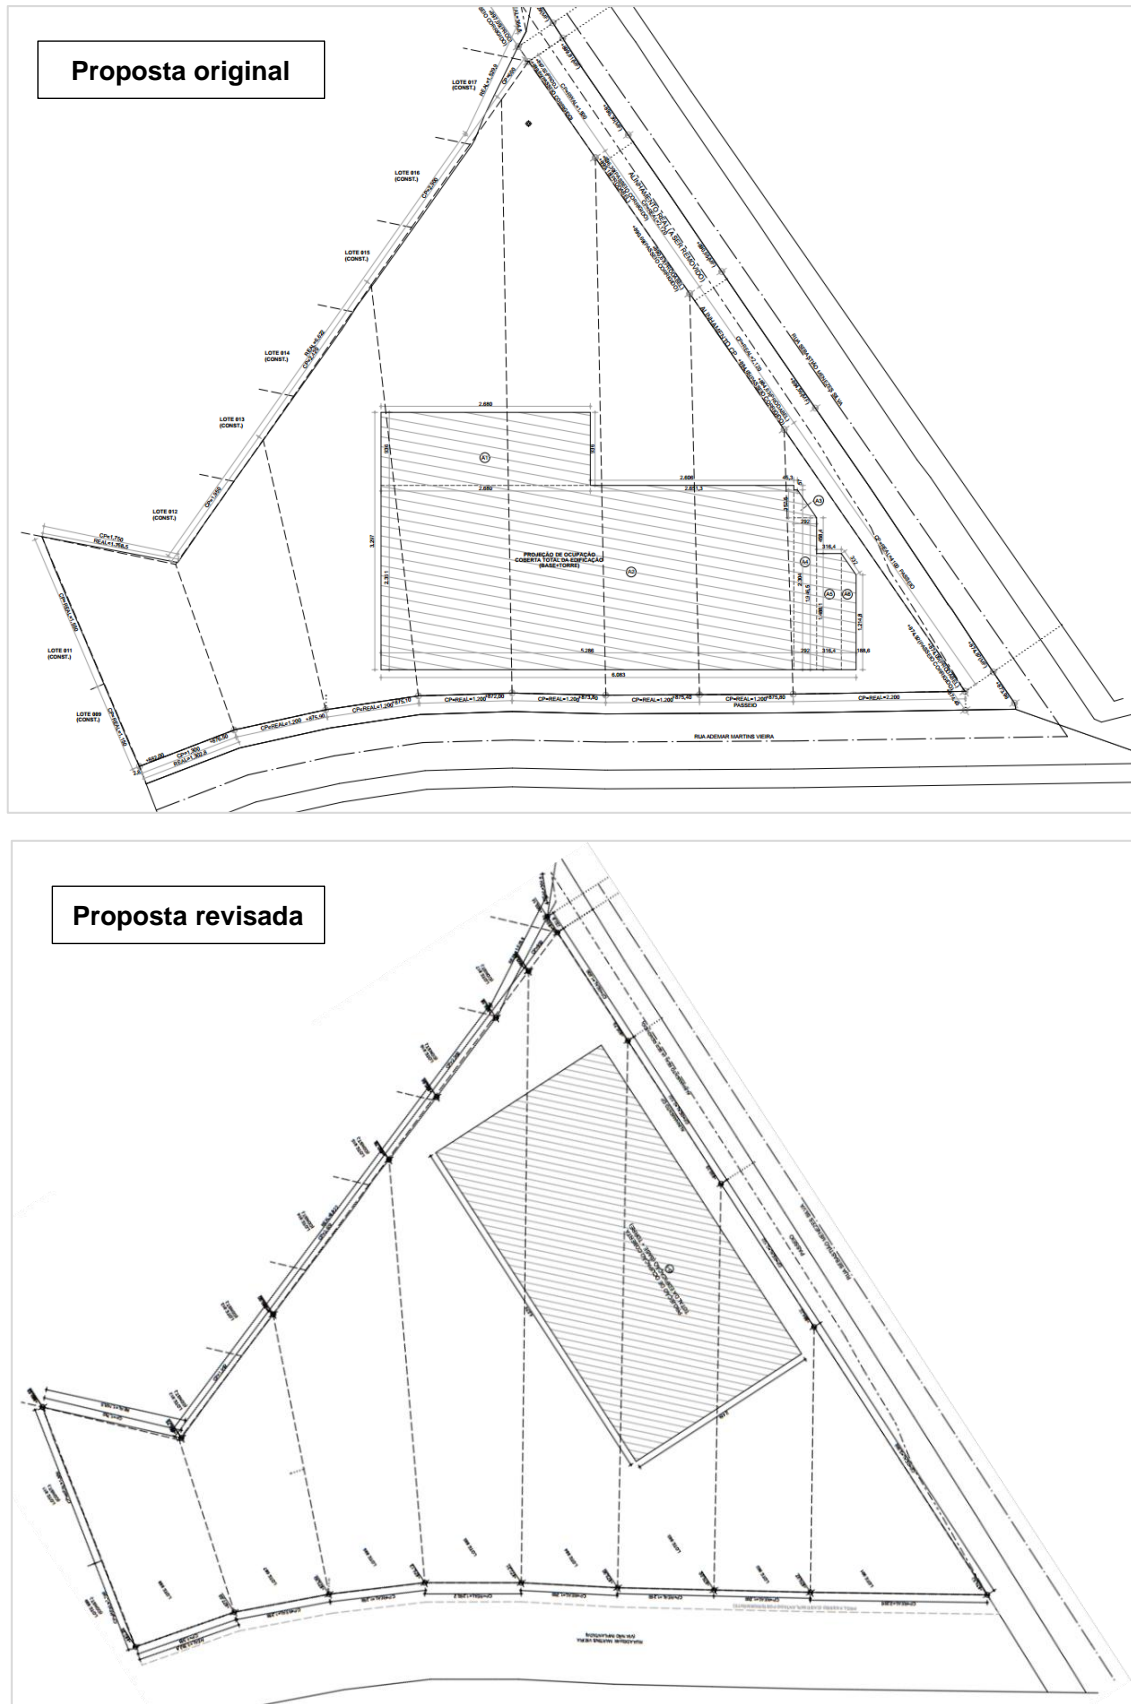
Comparativo entre a planta de ocupação original e a planta de ocupação revisada, evidenciando a alteração da localização da área de implantação da edificação no terreno.
